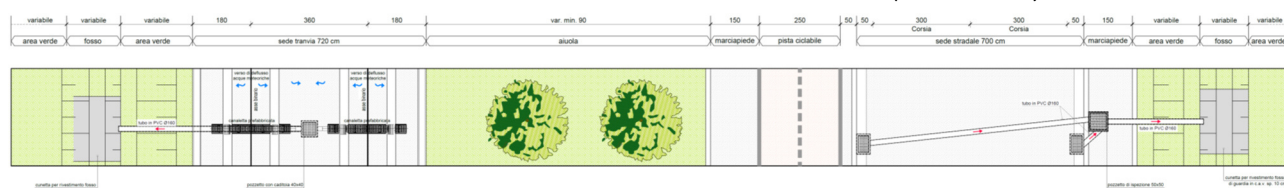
STRALCIO PLANIMETRICO SEDE TRANVIARIA IN PROSSIMITÀ DI AREE VERDI
